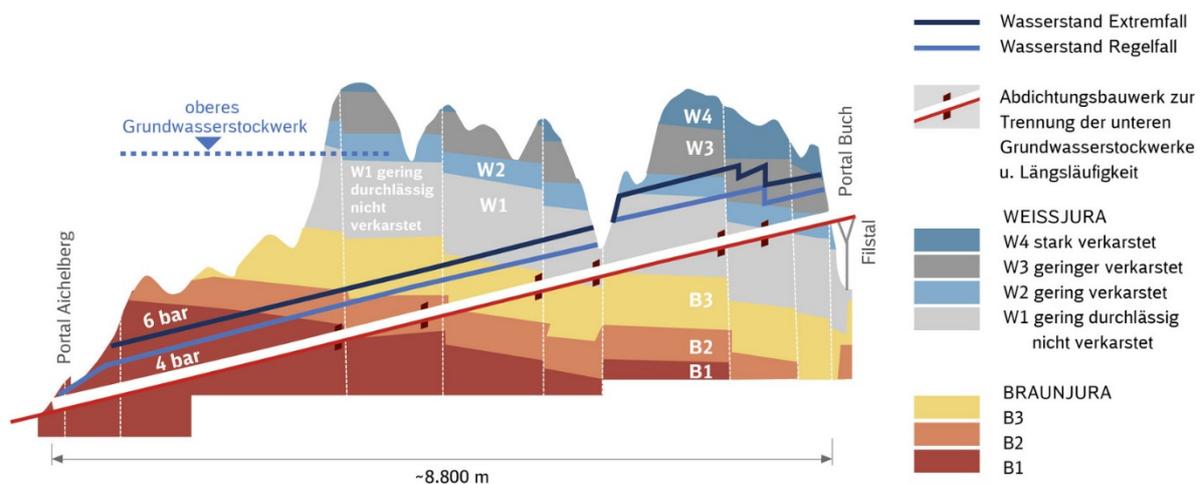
Geologisches Profil/Längsschnitt (Quelle: <http://www.bahnprojekt-stuttgart.de>)
